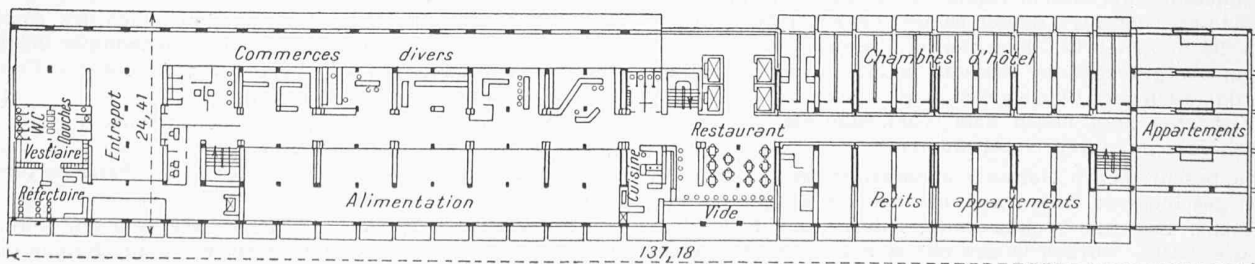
Grundriss des 8. Geschosses mit Läden, Restaurants, Hotel und Appartements, 1:800
